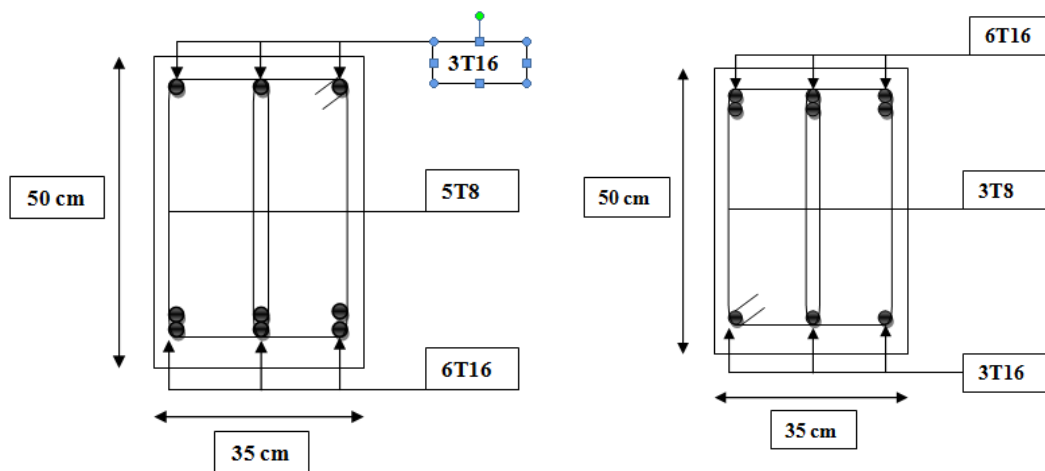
Ferrailage en Travée Figure IX.6 : Ferrailage en Appui
